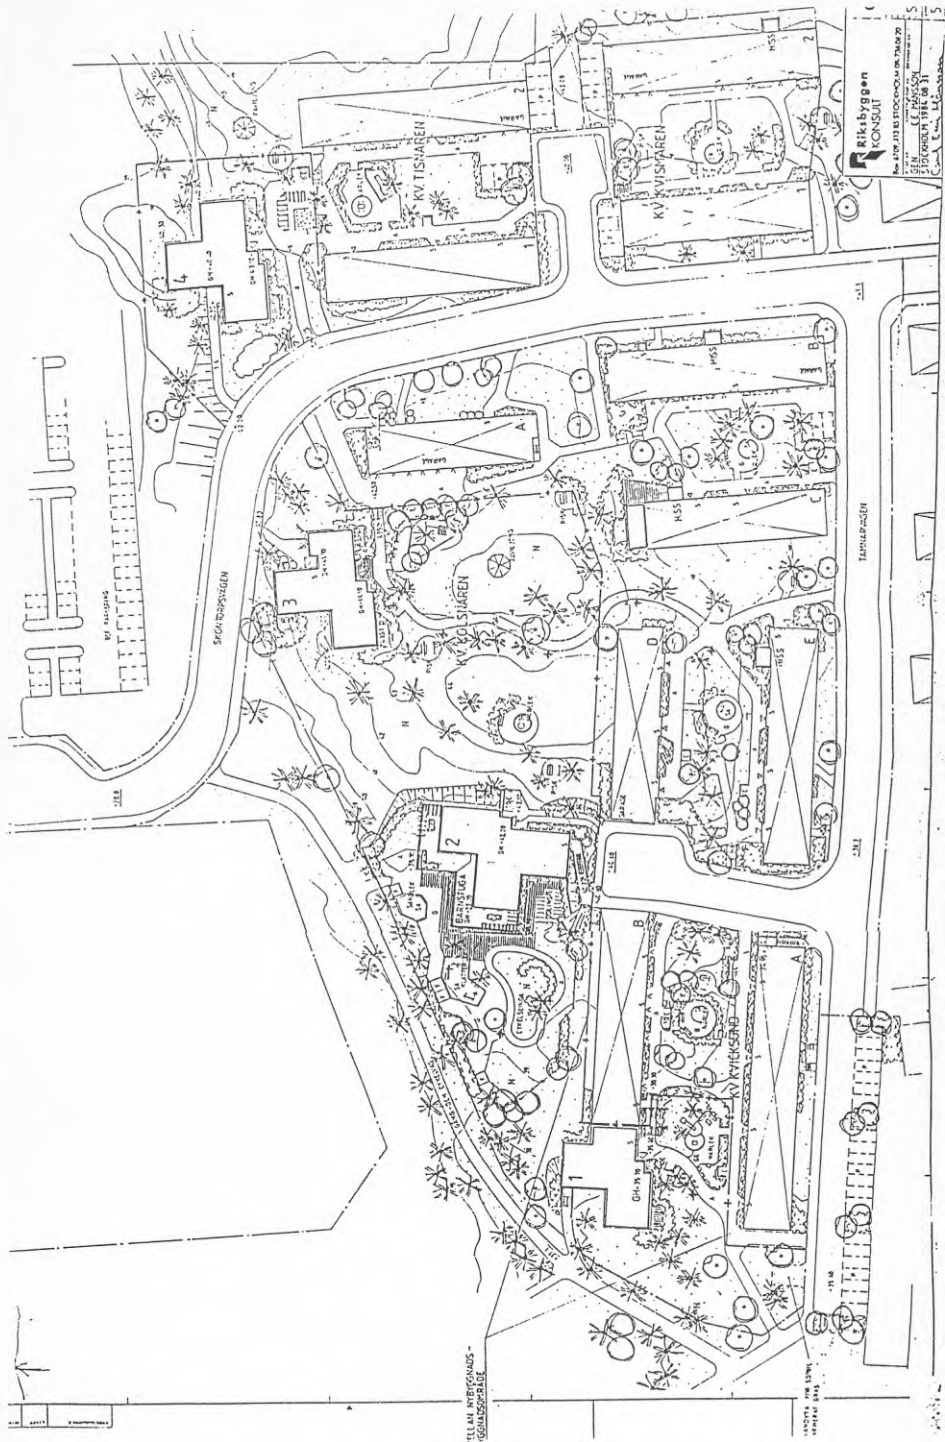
Det slutliga förslaget till planlösning av kv Kolsnaren/Hjälmarren. Arkitekt Jan Mizerski
